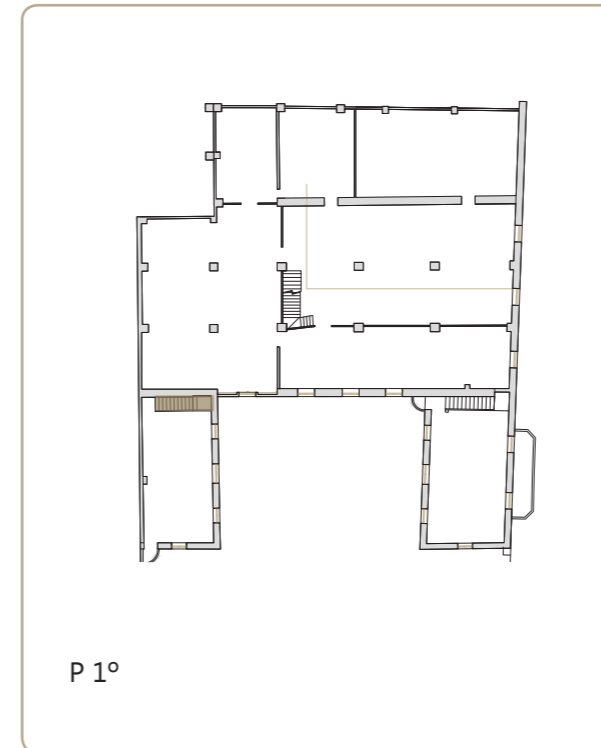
(Izquierda) Detalle de la escalera entre PB y 1º piso de nave lateral izquierda de fachada.
